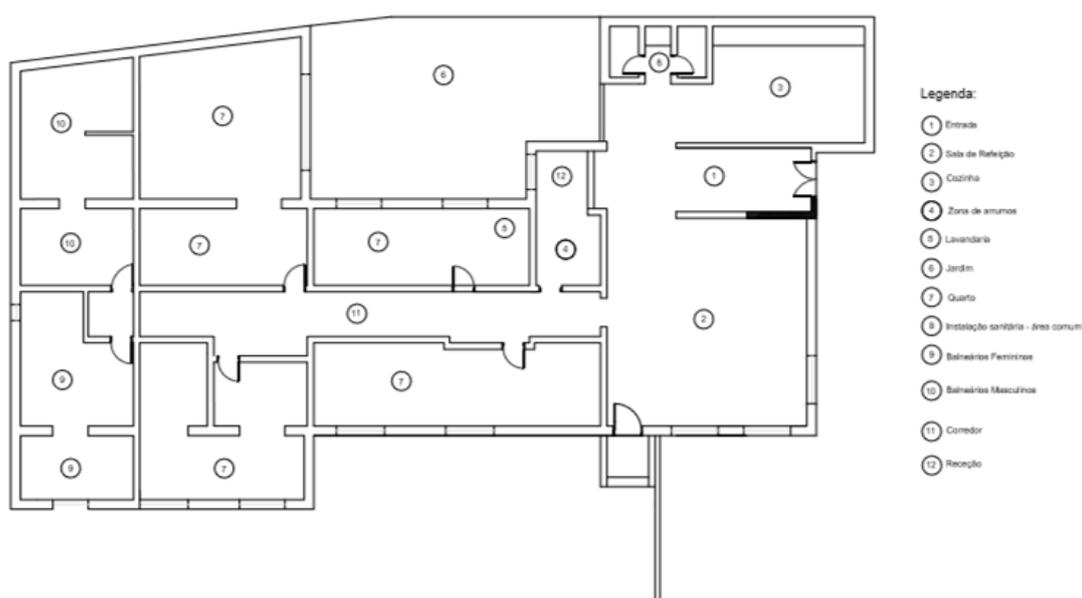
Planta do espaço atual do Hostel Casas da Mina
